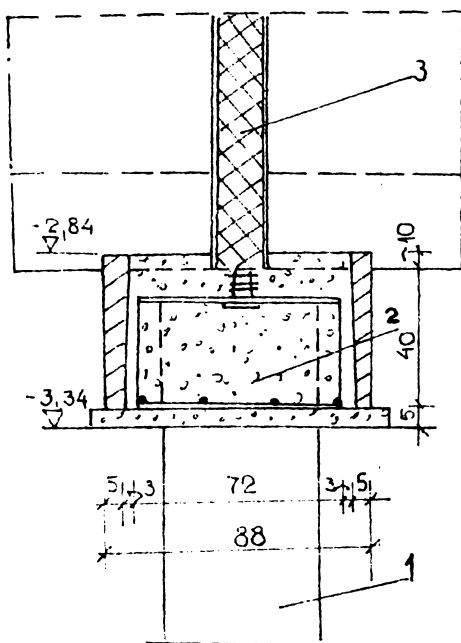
Sistem de fundații prefabricate (RPU): 1-pilot prefabricat; 2-grindă din beton turnată monolit; 3-panou de elevație prefabricat.
